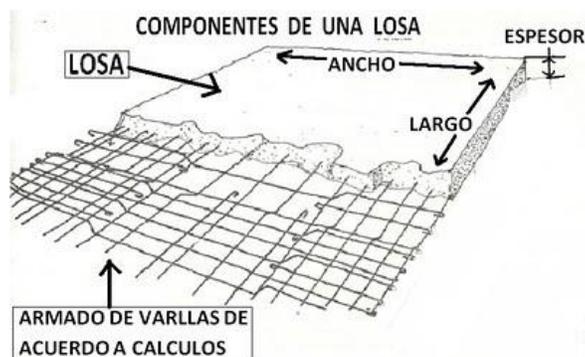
Losa de concreto armado. Tomado de página web: blogdelingeniero.com
